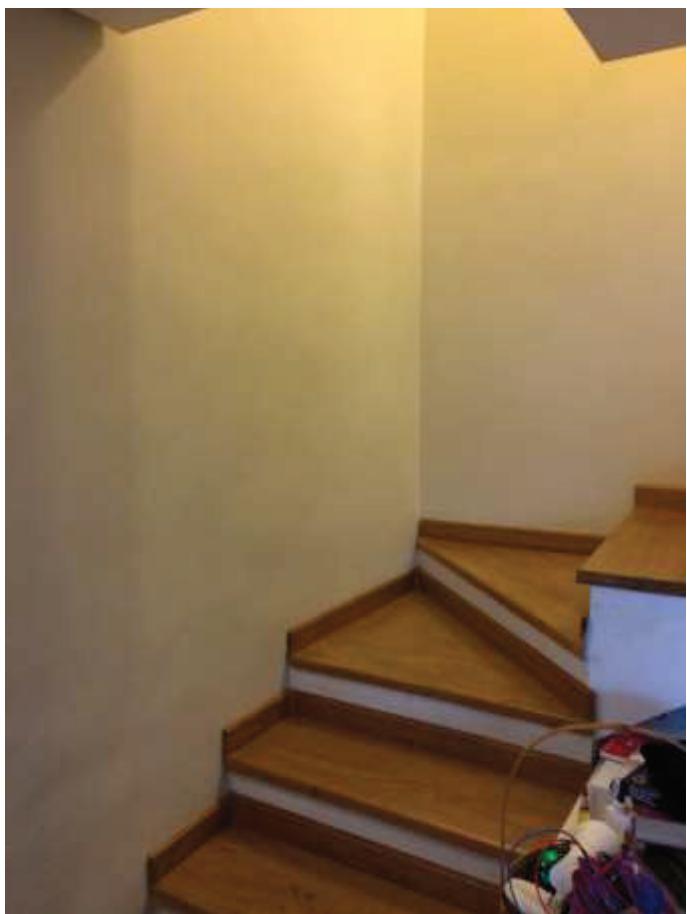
Escada de acesso ao pavimento superior - Fonte: Autor
